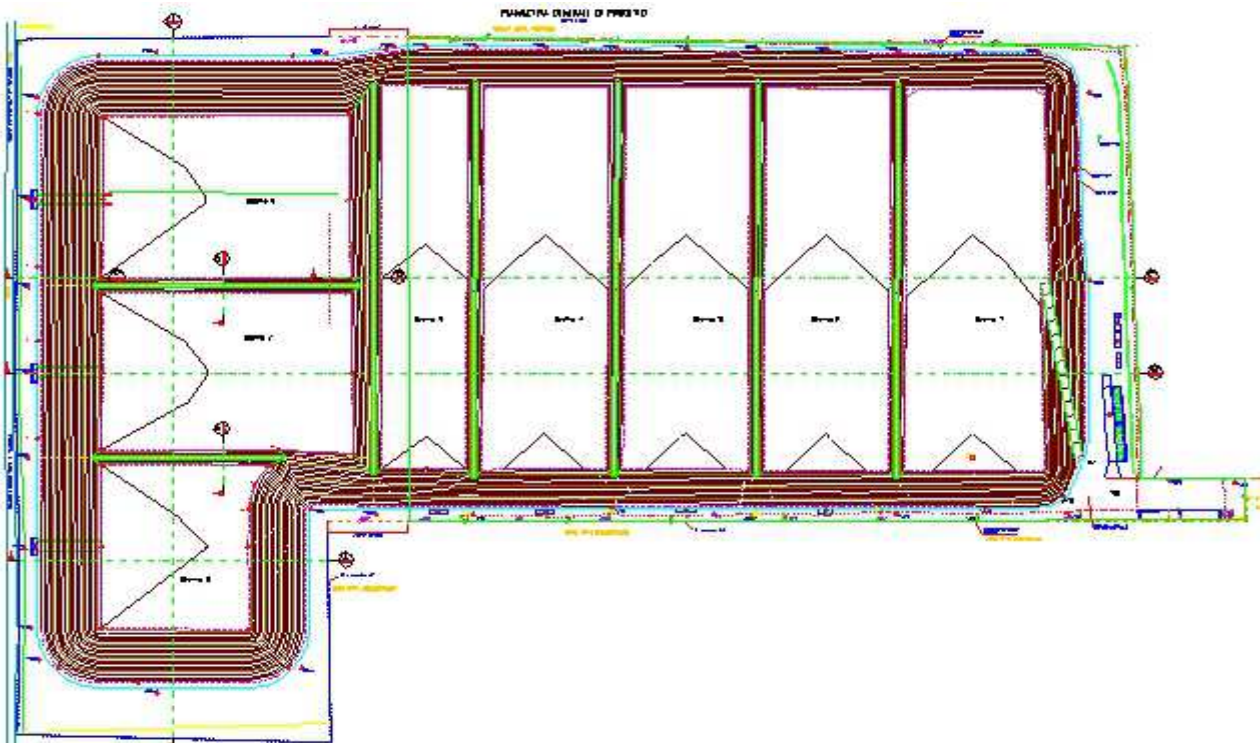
Planimetria della discarica (fondo posa rifiuti)
